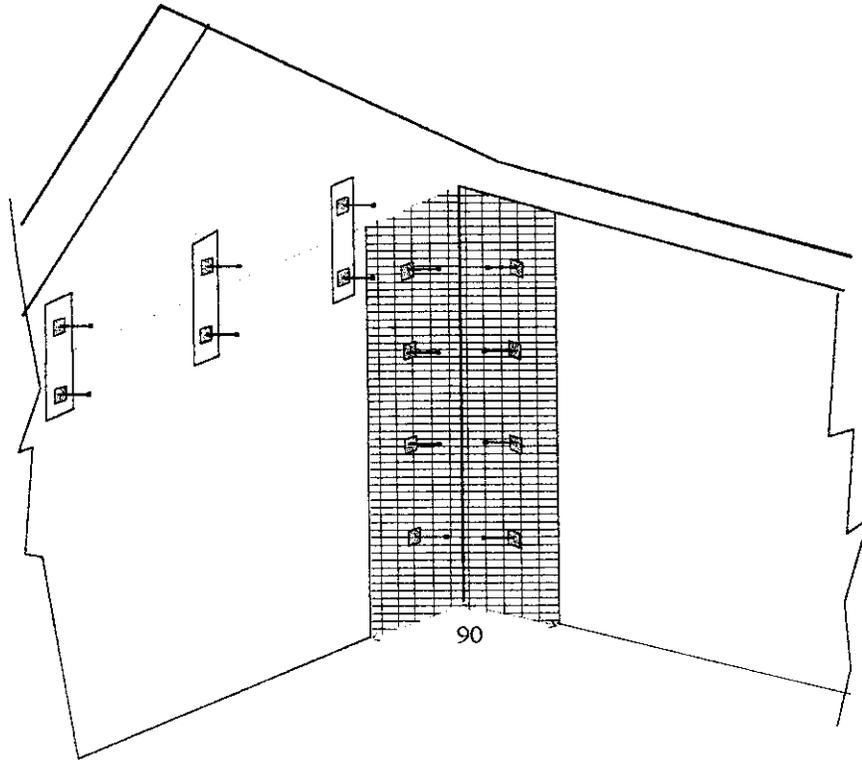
Instalación de la malla vertical continua (ancho 90 cm.)
